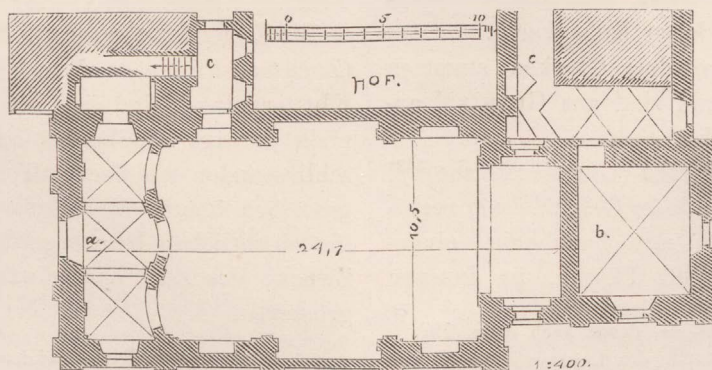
Graudenz. Grundriss der Zuchthauskirche.
